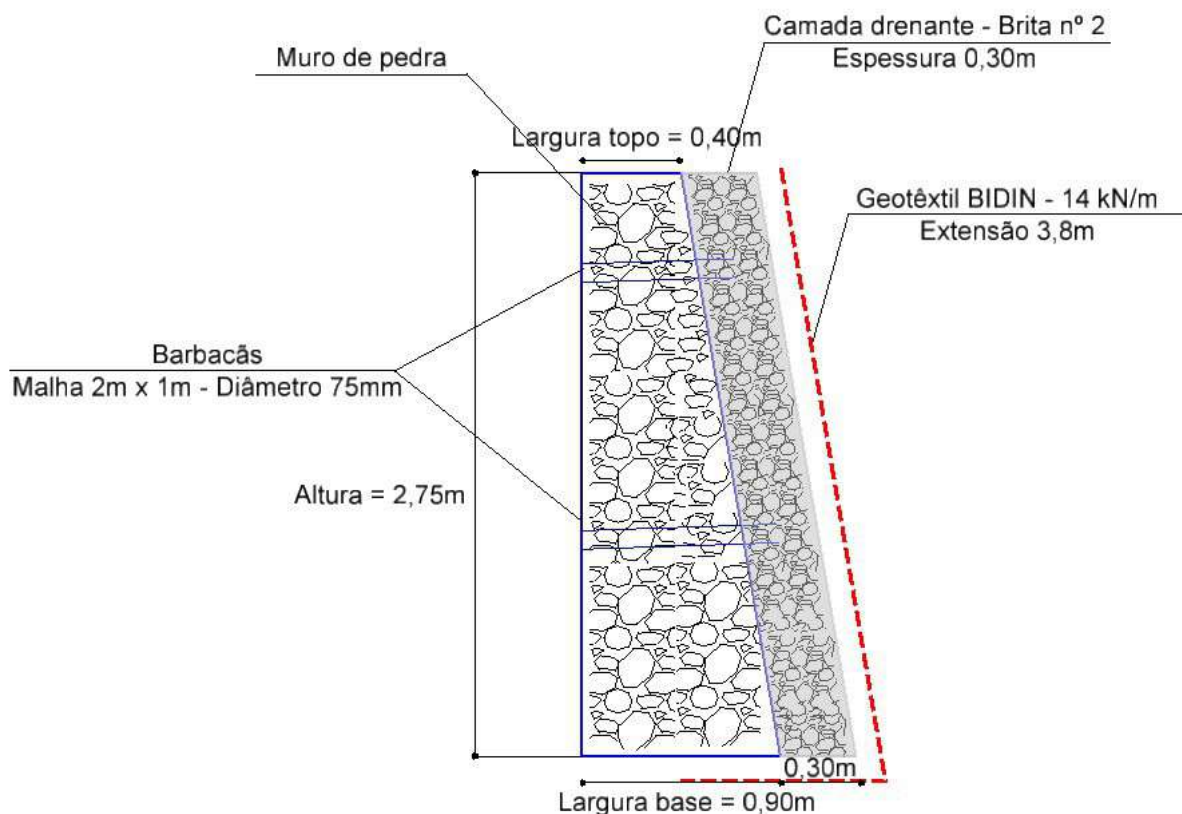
Seção do muro de pedra projetado na Avenida das Mangueiras
